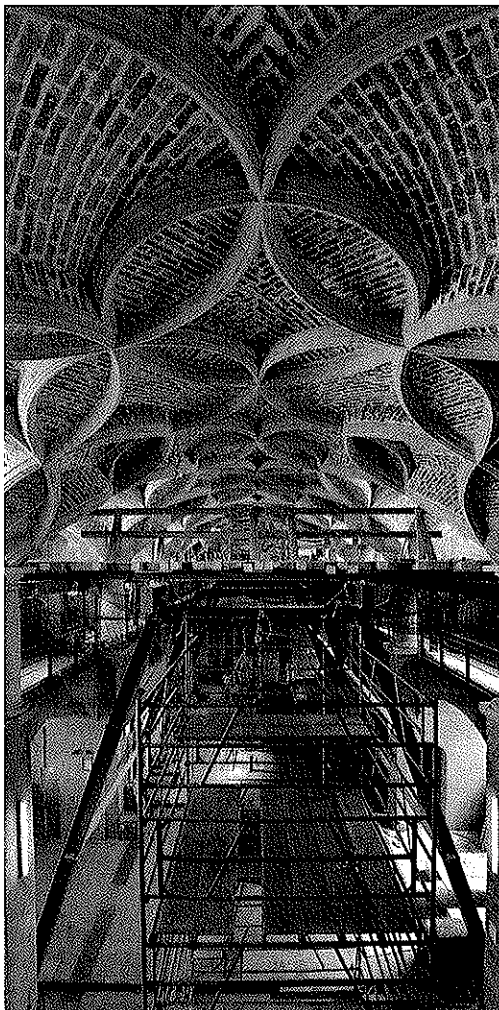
Rekonstruiertes Schlingrippengewölbe Schlosskapelle mit Arbeitsboden auf Stahlrahmen (Foto: R. Böhme)
